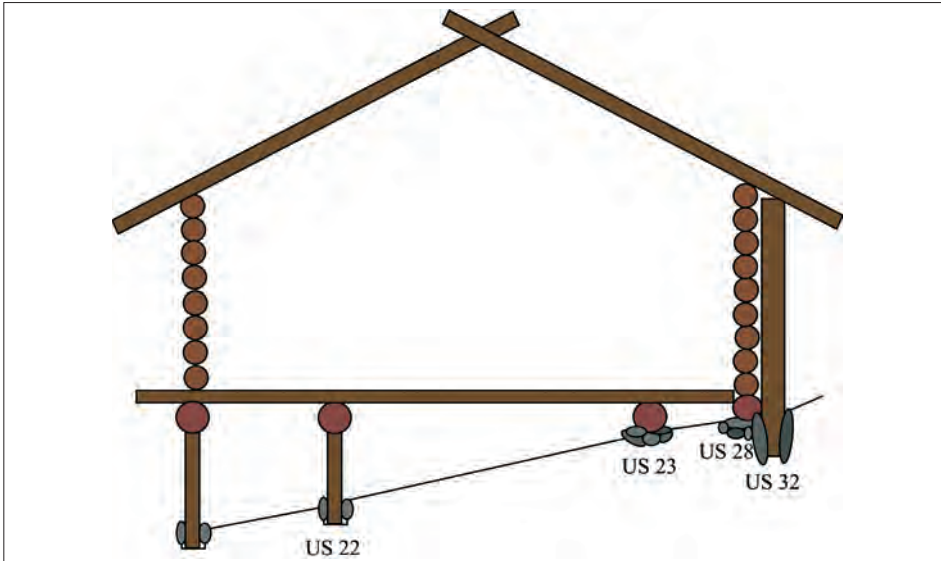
Ricostruzione ipotetica di una struttura a Blockbau con pavimento pensile
